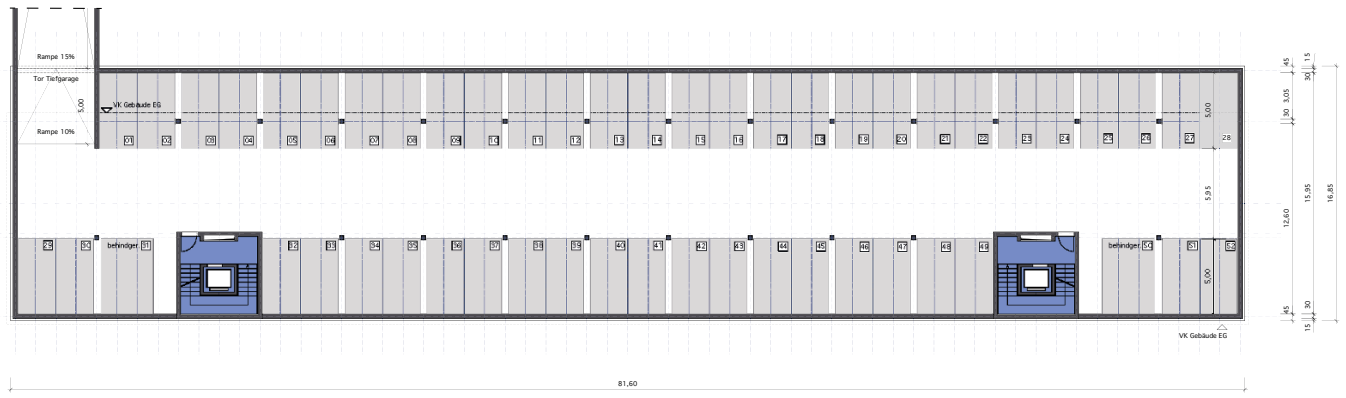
Grundrisse Referenzgebäude „geringe Variabilität“ für eine Büronutzung
